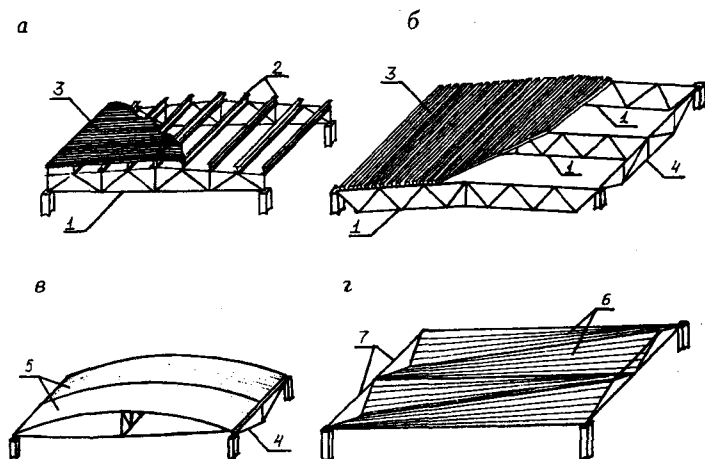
Конструктивные варианты покрытий: а — прогонное покрытие, б — беспрогонное покрытие; в, г — покрытия из цилиндрических и гиперболических панелей-оболочек «на пролет»; 1 — стропильные фермы; 2 — прогоны; 3 — профнастил; 4 — подстропильная ферма; 5 — цилиндрические панели-оболочки; 6 — гиперболические панели-оболочки; 7 — распорки
